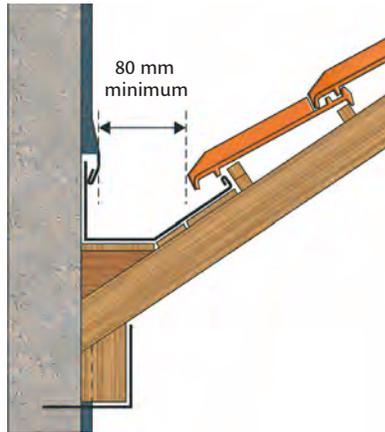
Chéneau avec tuiles à emboîtement (de terre cuite ou en béton)
